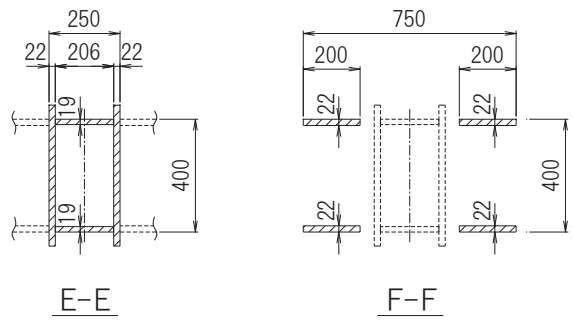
(4) 筒身連結材の構成断面 (単位 : mm)
